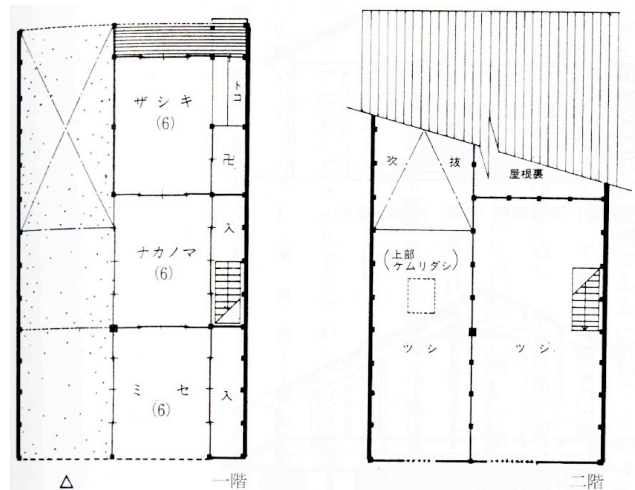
旧枚方宿大塚家一階、二階平面図
